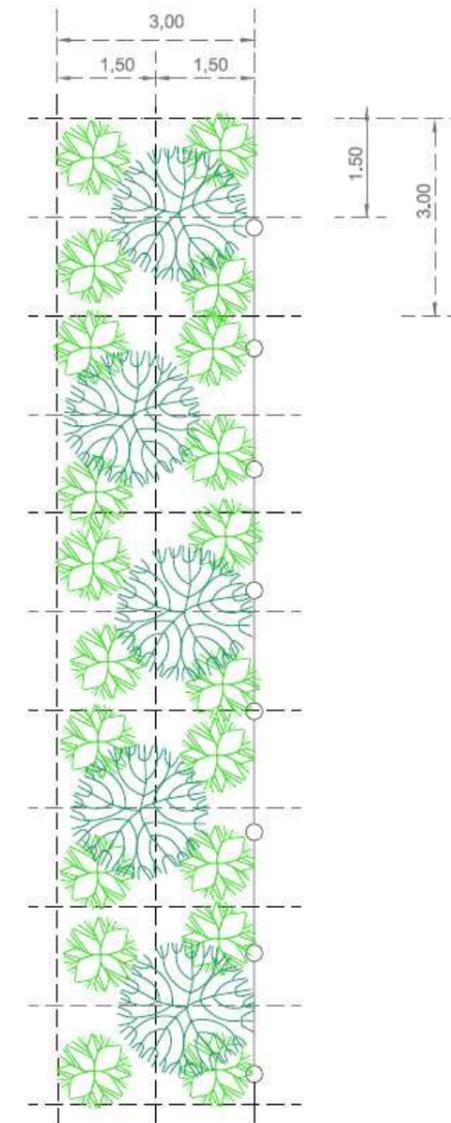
B- Planimetria Nuova stazione Udine Sud Alternativa con Formazione Fascia boscata
